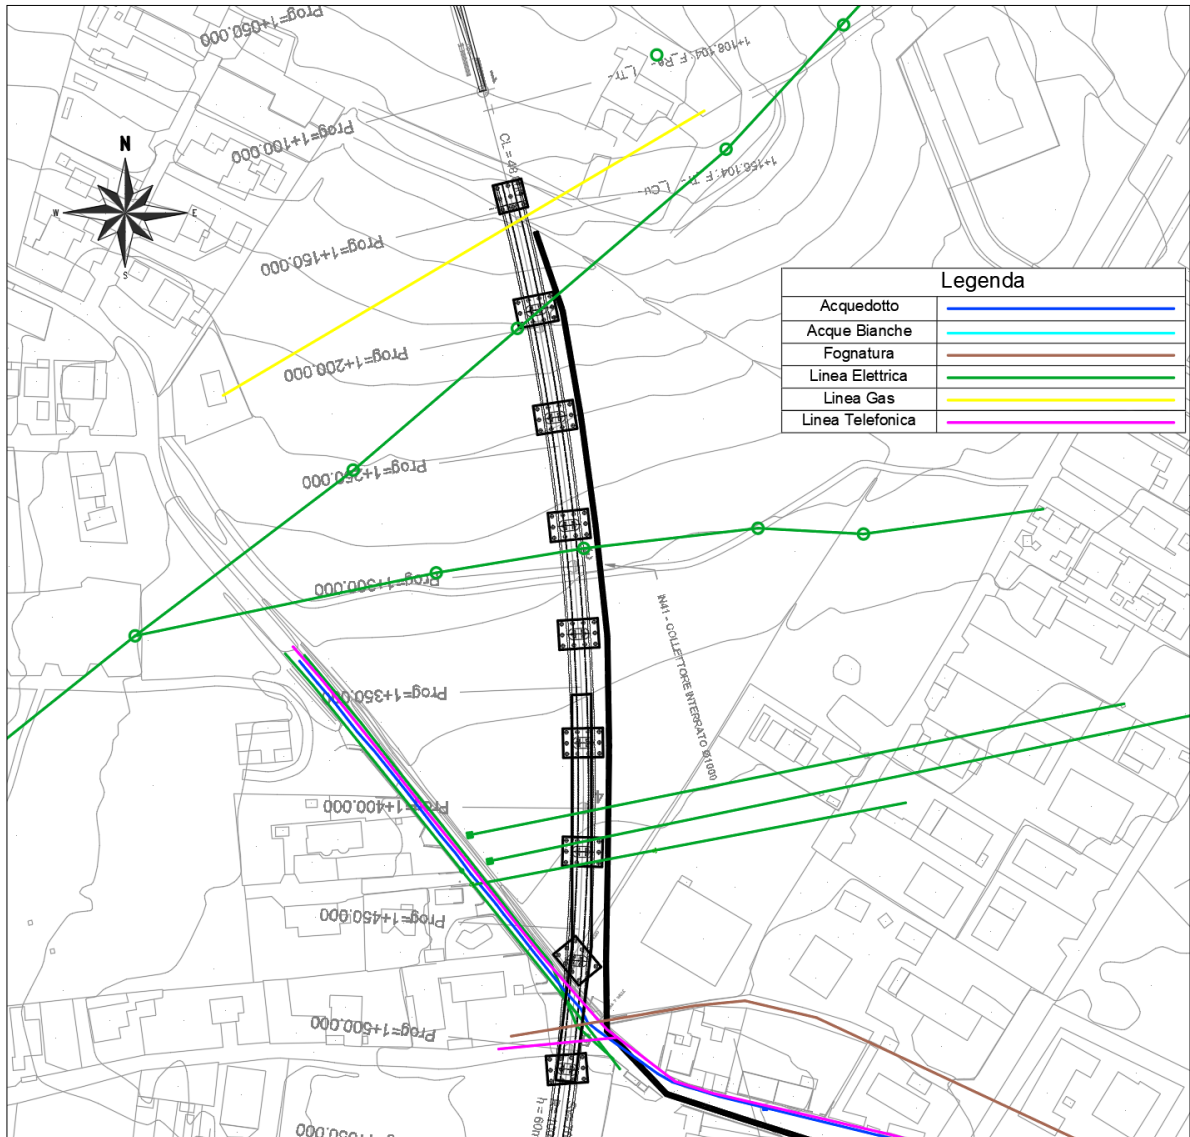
Disposizione planimetrica dei sottoservizi rilevati in Area 2
